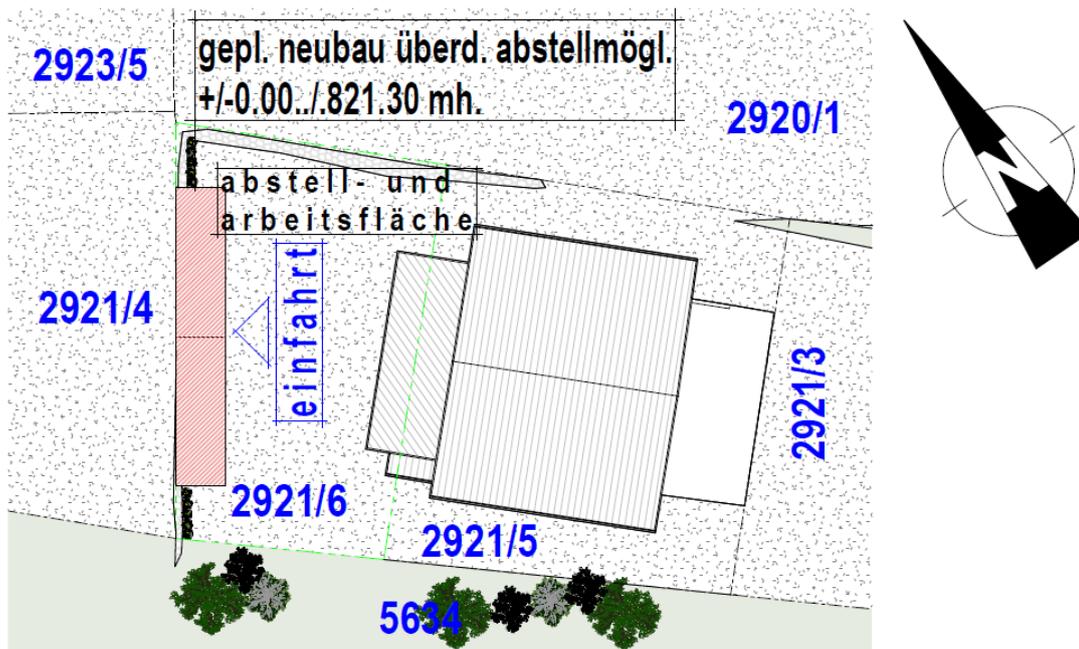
Übersichtsplan aus den Planunterlagen seitens des Planungsbüros m³ PLAN + BAU GmbH (ohne Maßstab)
